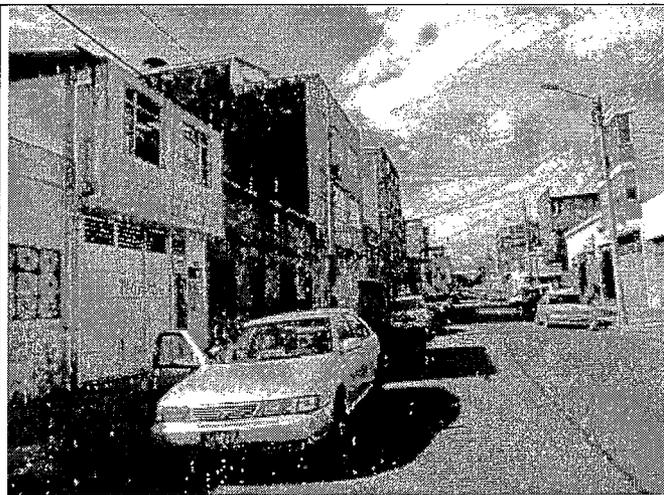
Vista de la vía de acceso al sector en sentido Norte – Sur, Cra. 53
